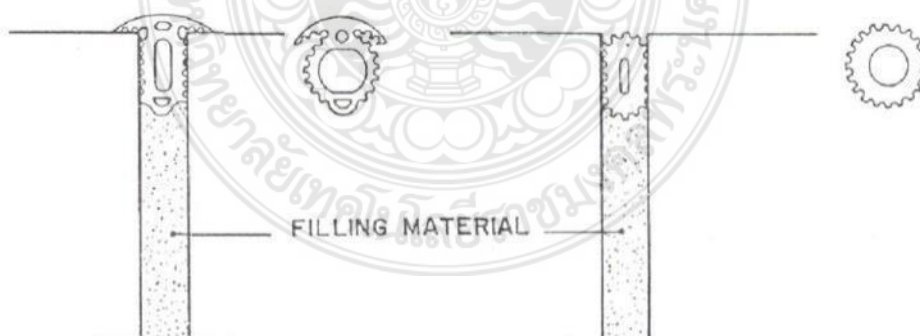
รายละเอียดและระยะต่างๆ ของ Open-drained Joints ที่พัฒนาจากแบบทดลองในยุคนแรกของ Building Research Station และนิยมใช้กันในตอนหลัง
